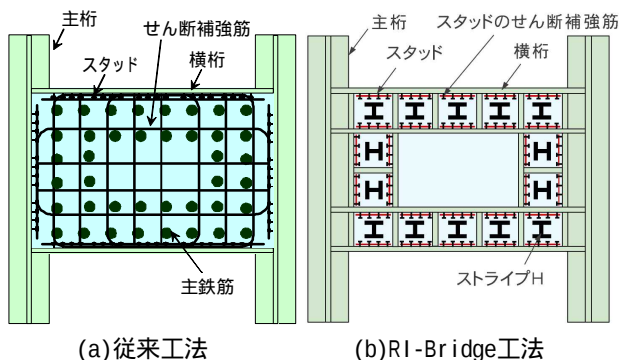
従来剛結工法とRI-Bridge工法の剛結部形状
